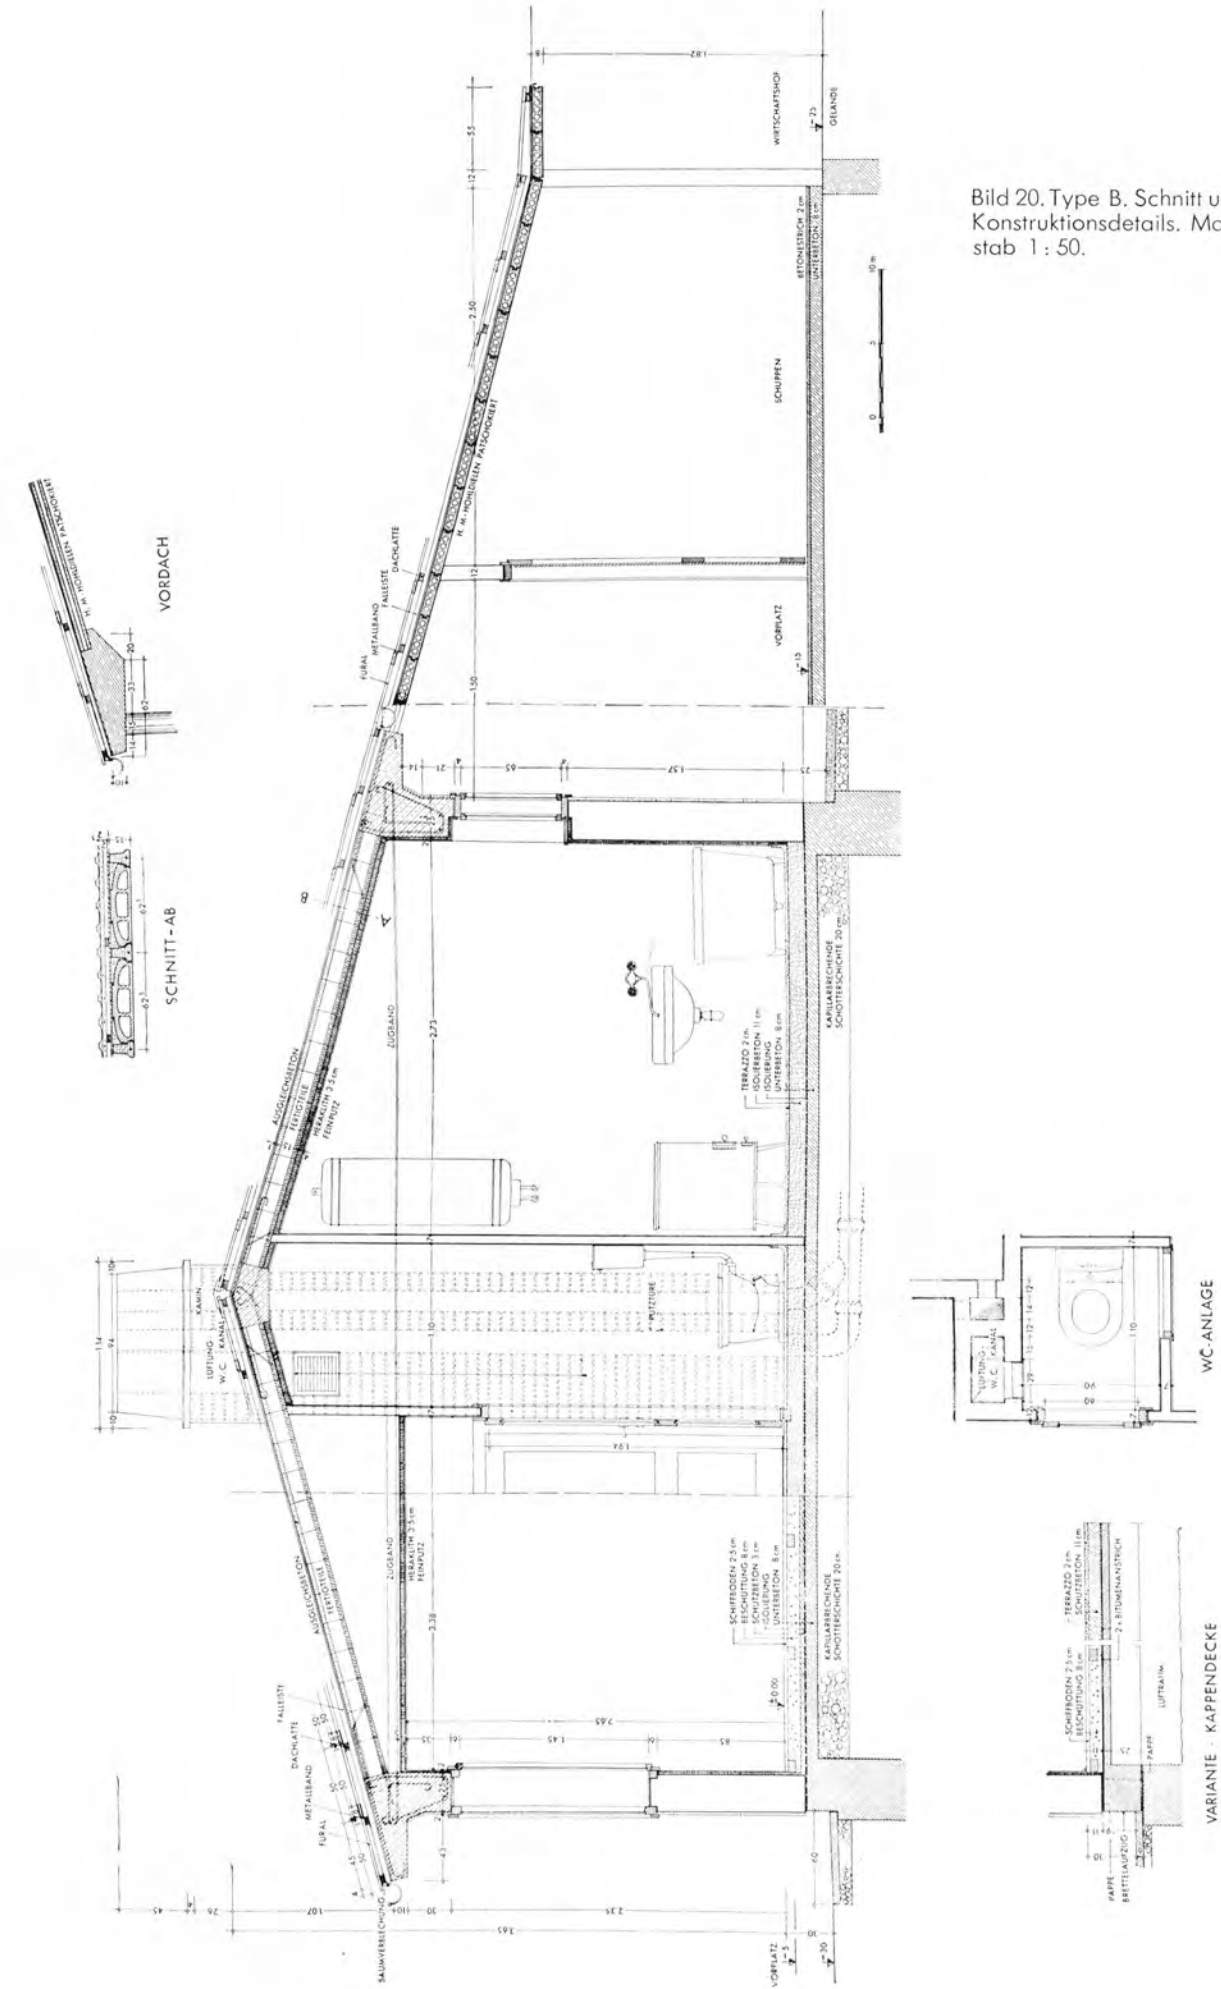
Type B. Schnitt und Konstruktionsdetails. Maßstab 1:50.
